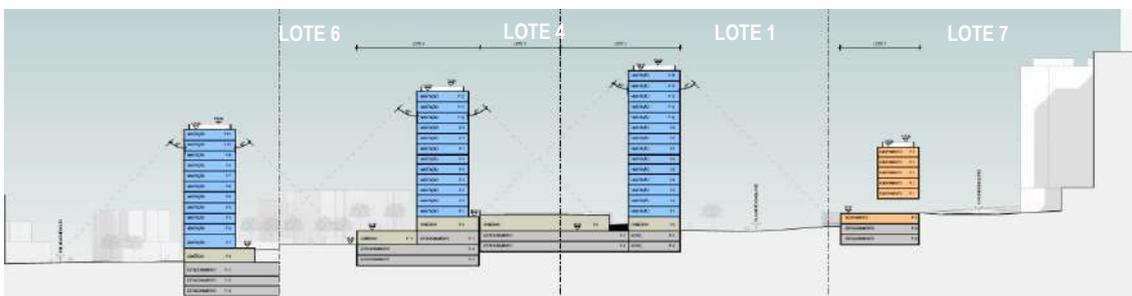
Perfis da proposta do Loteamento, lote 1, 4, 6 e 7.
